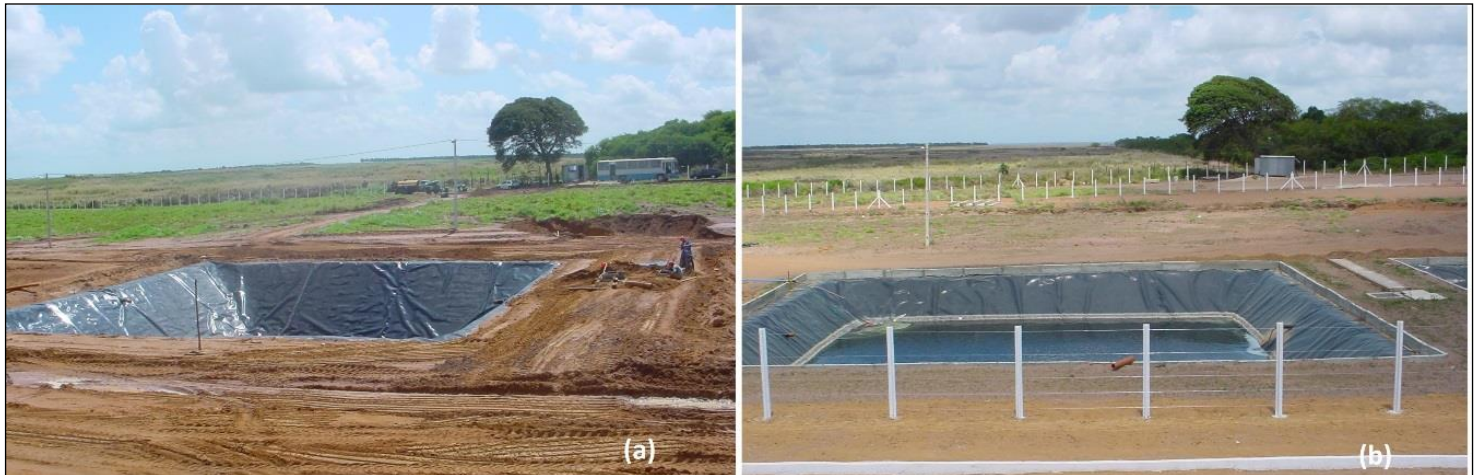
Lagoa de percolado Aterro RMN - (a) instalação da manta (b) lagoa em operação
